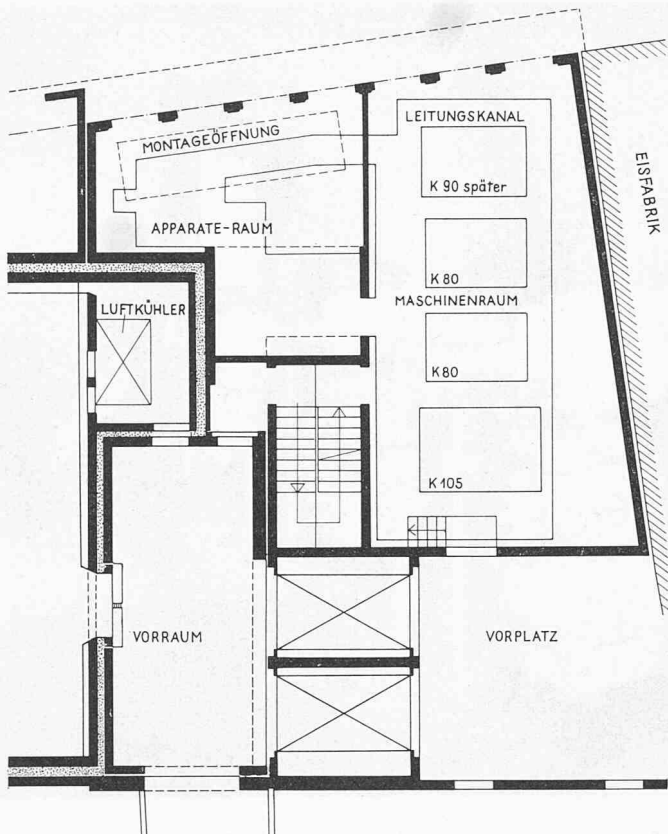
Grundriss des Maschinenraumes mit Nachbarräumen im Untergeschoss, 1:200
